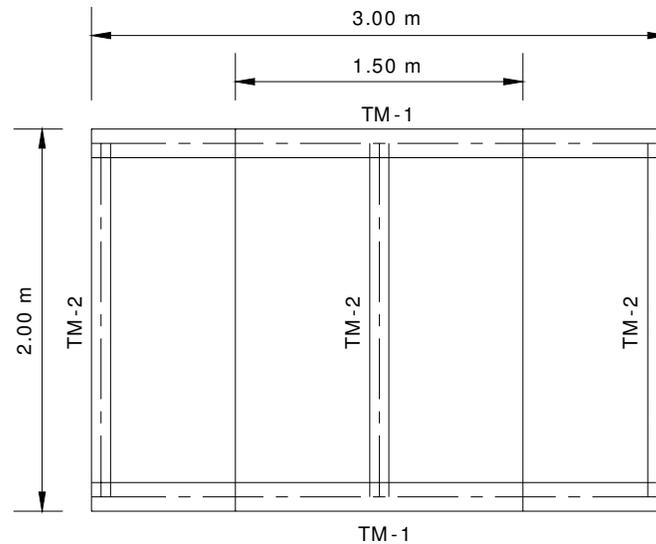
Distribución en planta de las vigas de los puentes de acceso, edificio Victoria 7
